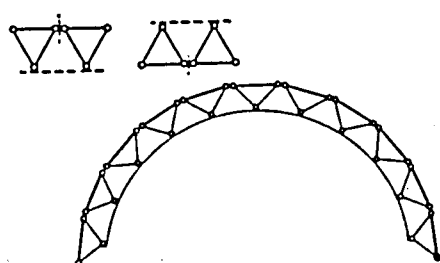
Disposição longitudinal das peças pré-fabricadas de três membros
